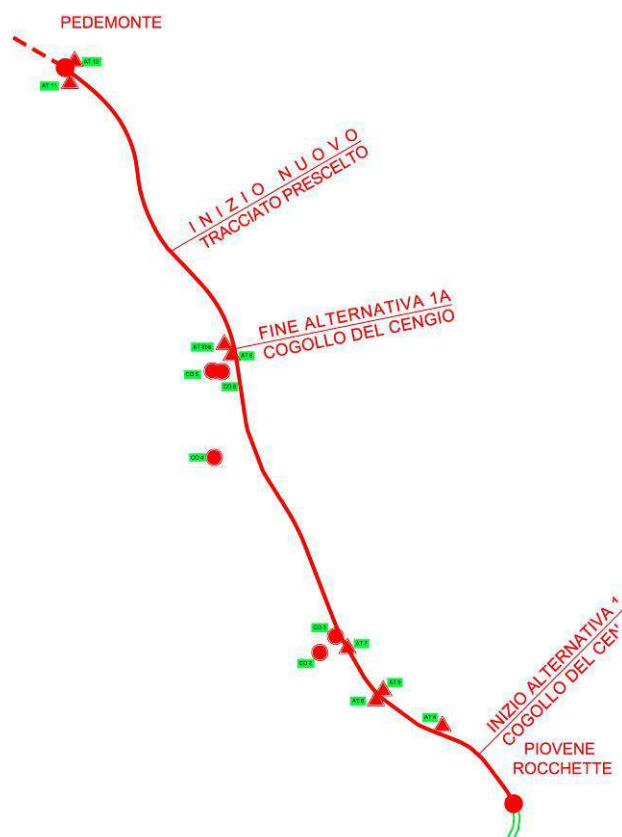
Localizzazione delle aree di cantiere lungo il tracciato
